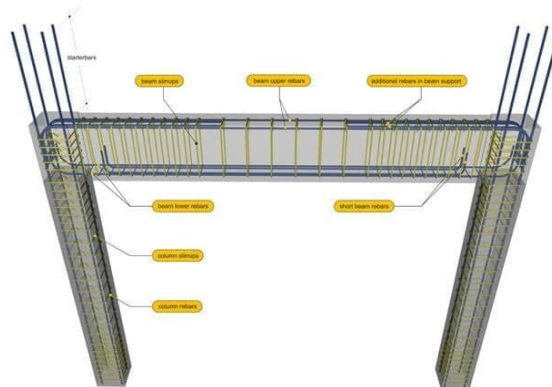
le ferrailage d'un portique (source : buildinghow.com)
